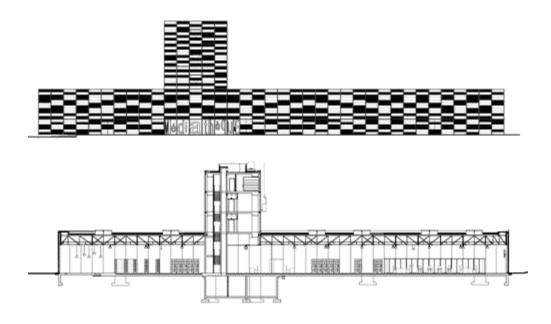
Fachada y corte arquitectónico, Mediateca de Venissieux.
